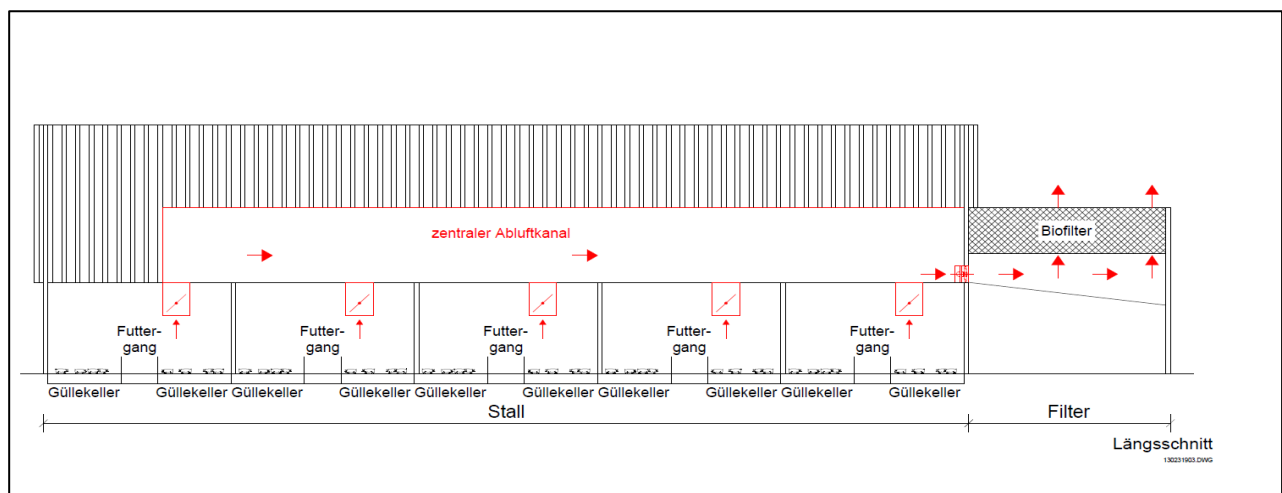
Längsschnitt Jungsauensall mit Darstellung der Ablufführung
